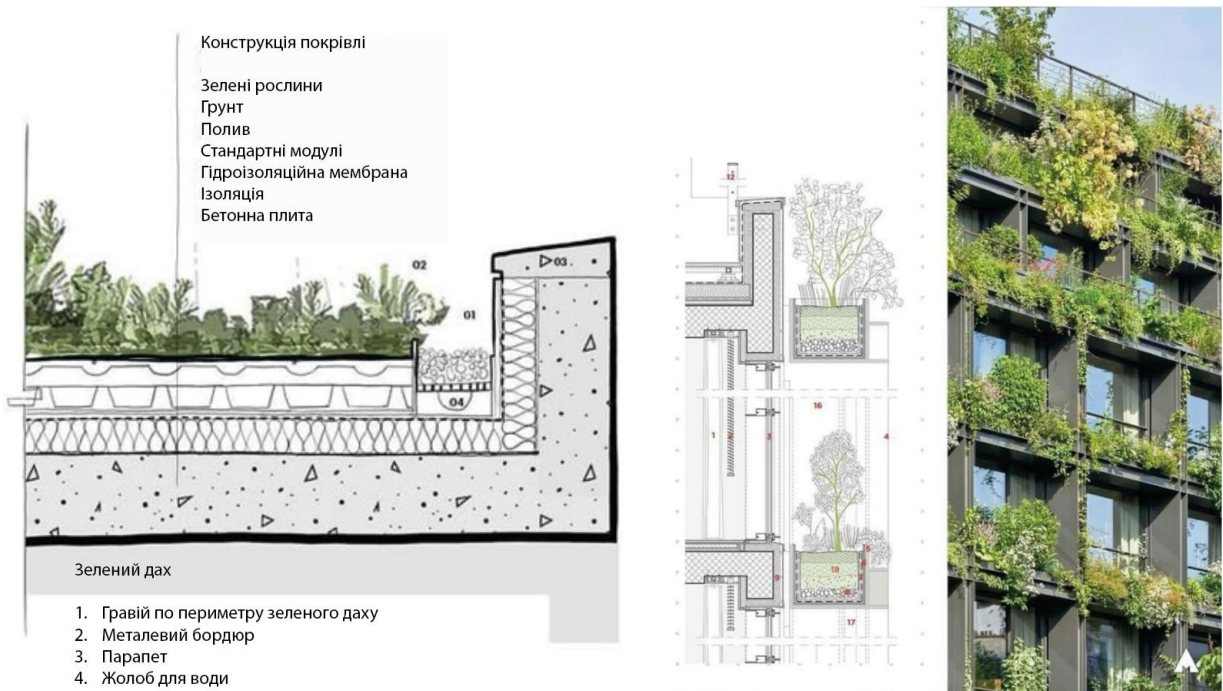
Схема зеленої покрівлі та фасада [59].
